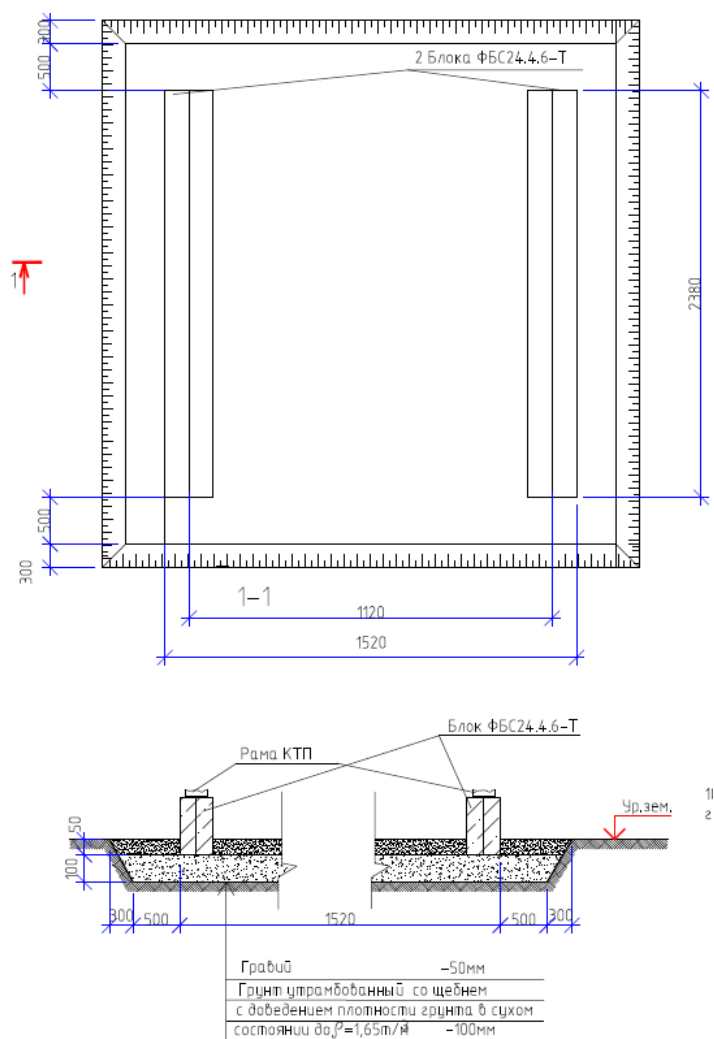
Схема установки КТПК на фундамент из блоков ФБС24.4.6-Т
